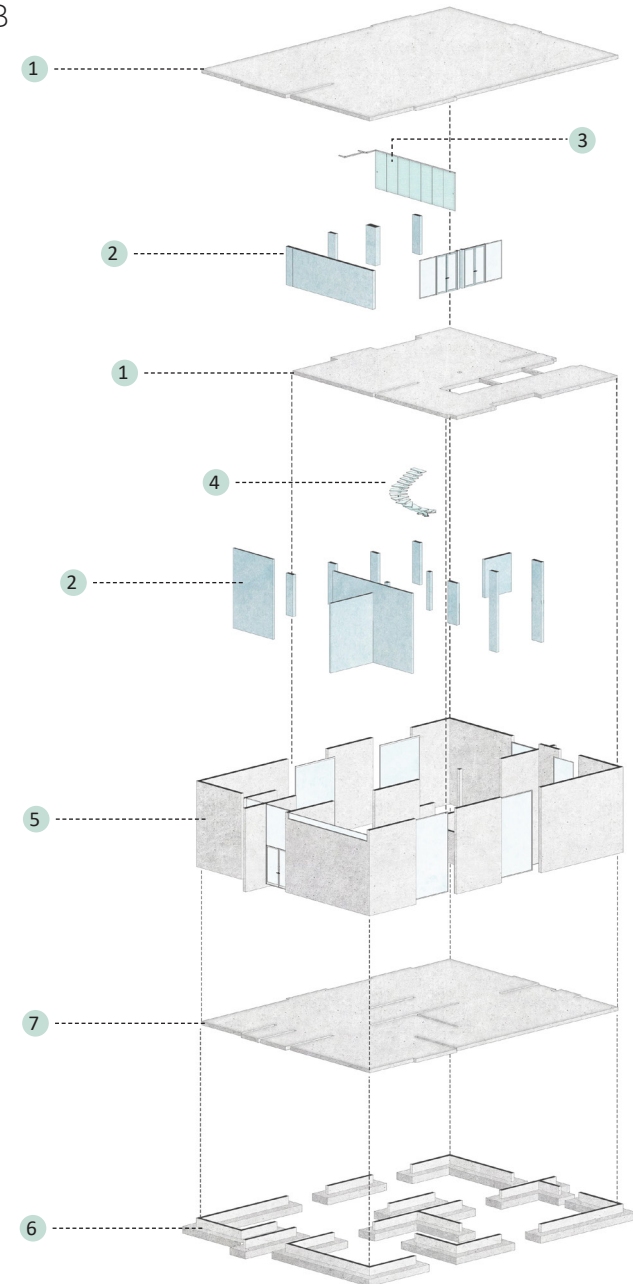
Axonometría explotada de sistema estructural de bloque A y B.
